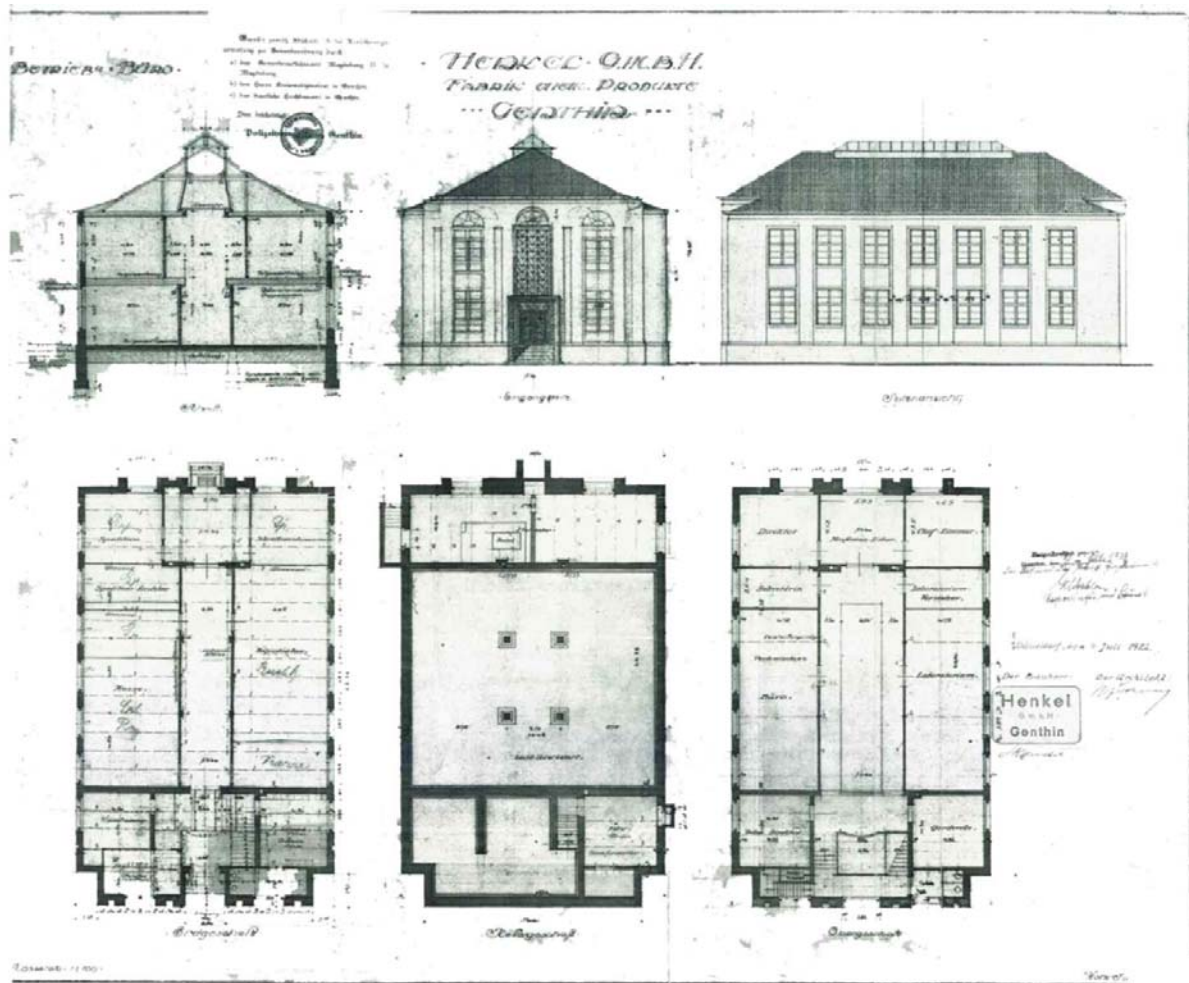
Verwaltungsbau Genthin – Entwurfszeichnungen vom 4. Juli 1922 [Schnitt, Ansichten und Grundrisse (Erd-, Keller- und Obergeschoss)]– Architekt: Walter Furthmann
